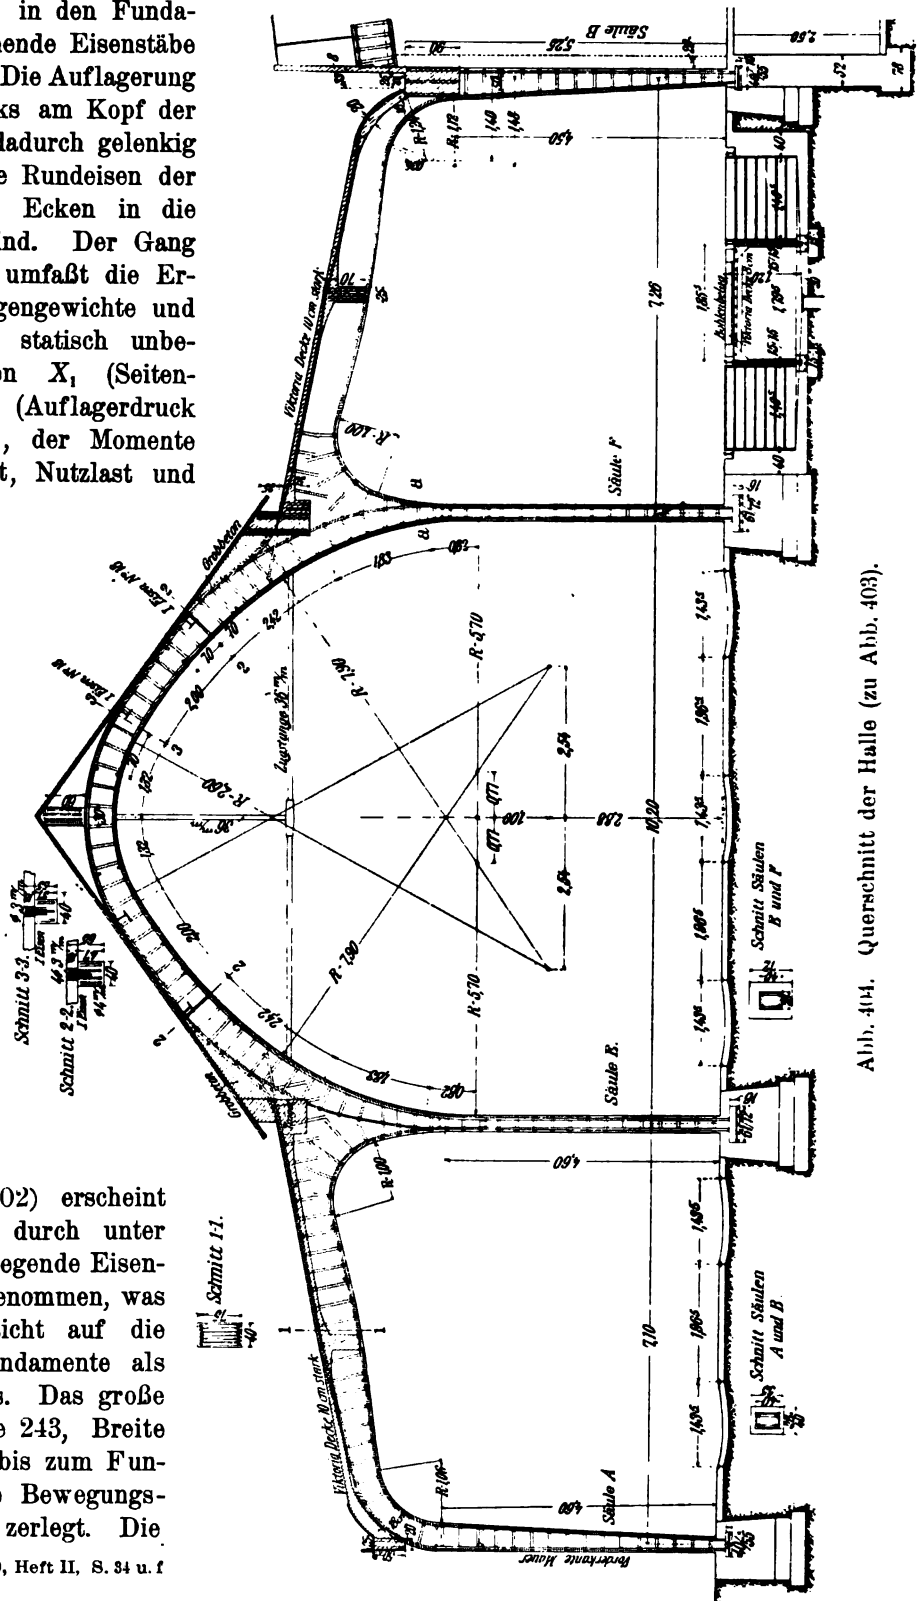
Querschnitt der Halle (zu Abb. 403).
